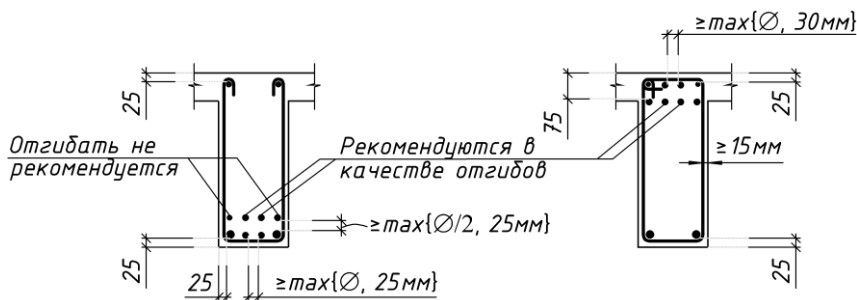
Расположение продольной арматуры в поперечном сечении балки
